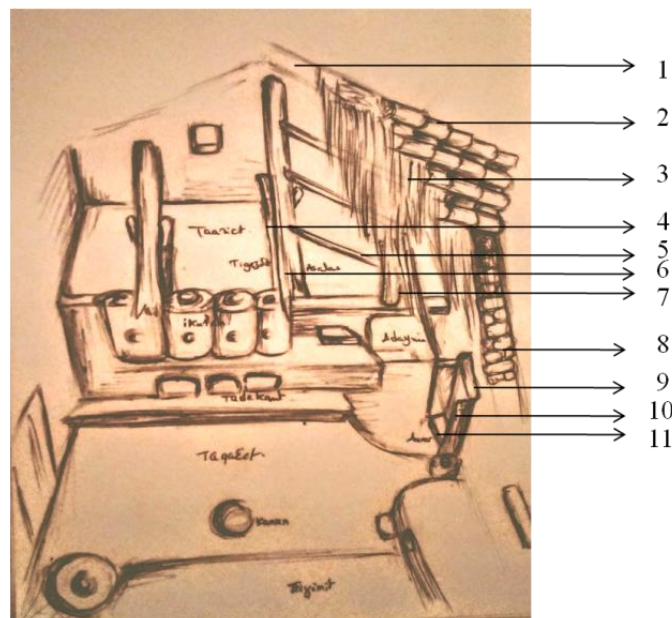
Croquis avec sa légende du système constructif d'une maison traditionnelle
